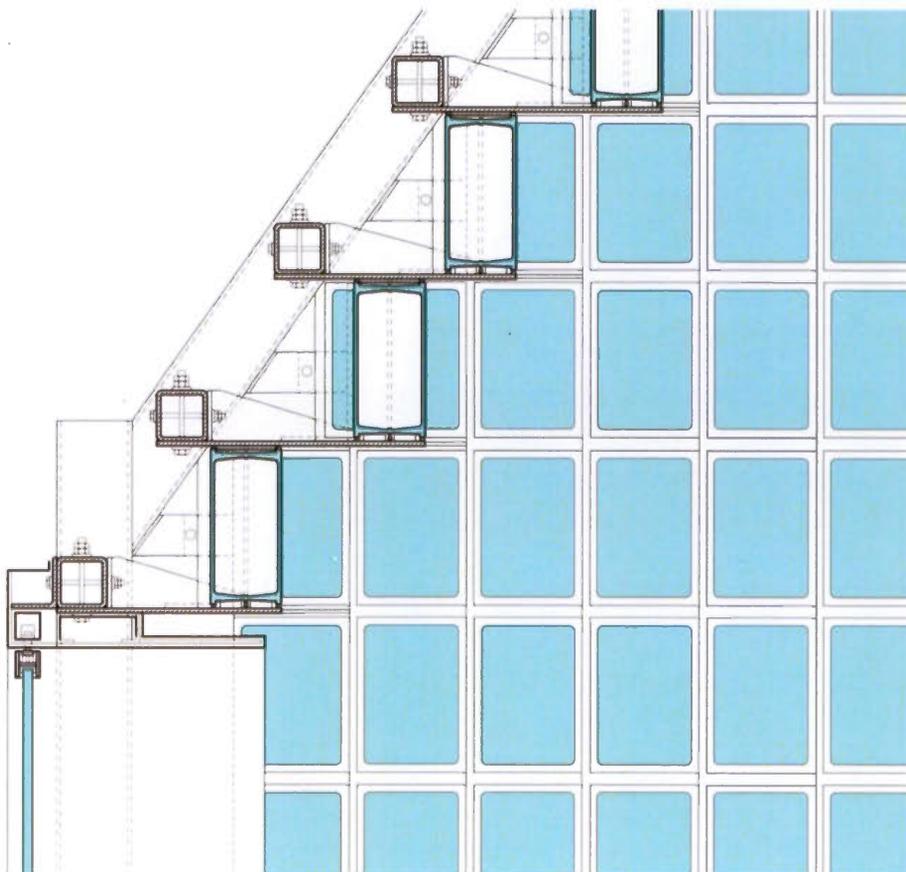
DETAIL, couverture du numéro consacré aux systèmes de façades, 2018
